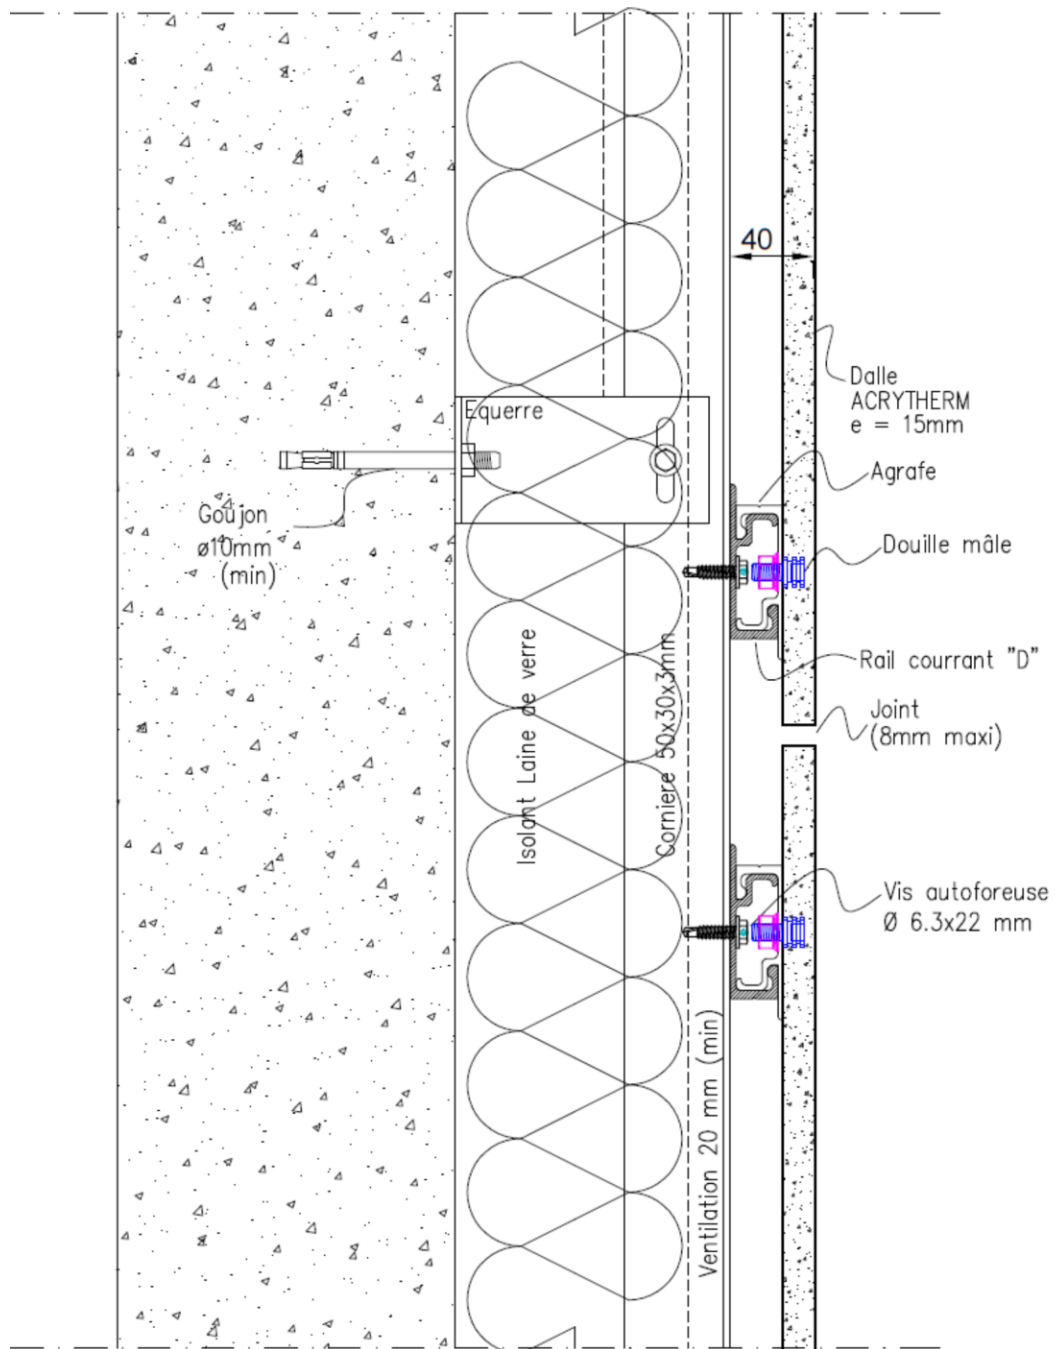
Coupe verticale sur joint courant avec douille mâle
